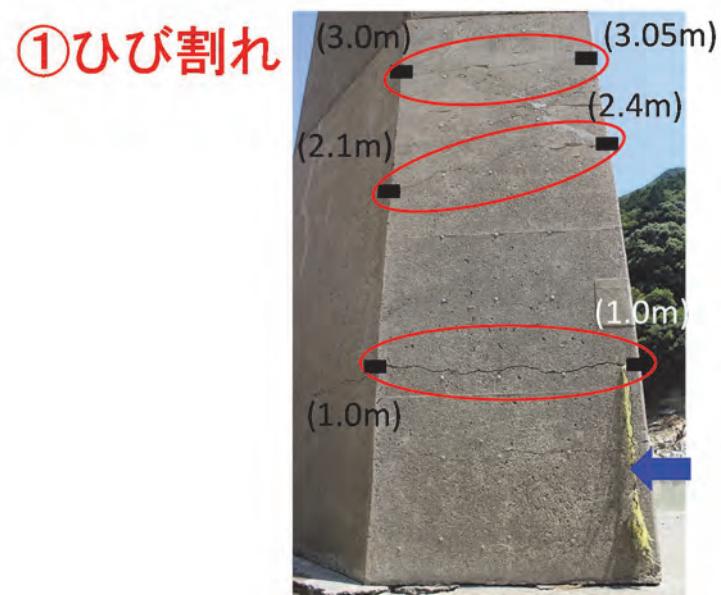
P2 橋脚基部のひび割れの状況 (A2 側から撮影)
